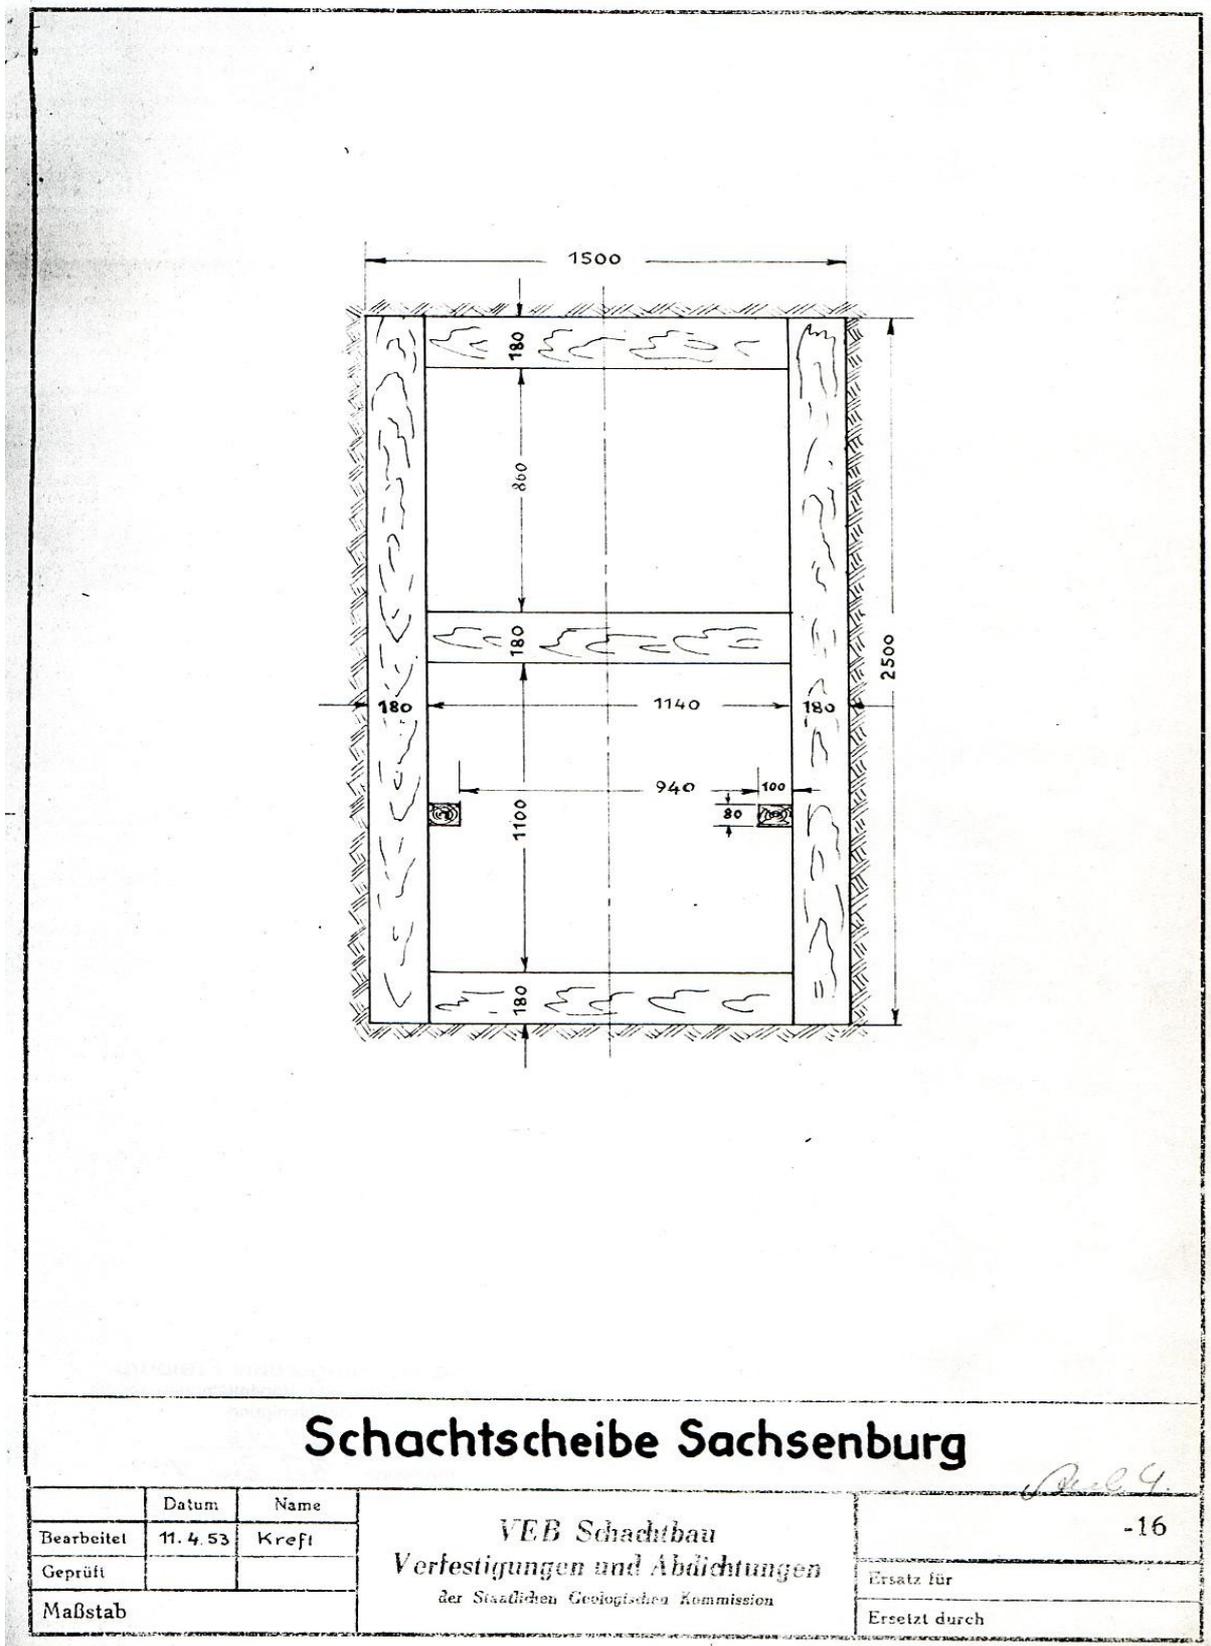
technische Zeichnung der Schachtscheibe des Gesenkes.
